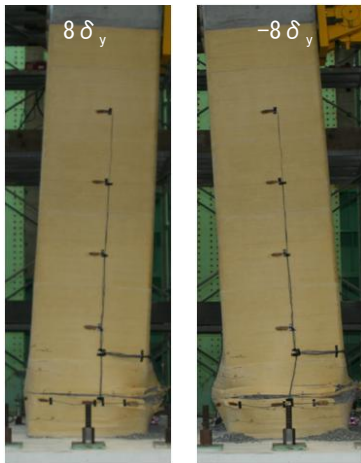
試験体の損傷状況 (試験体 No. 1)
